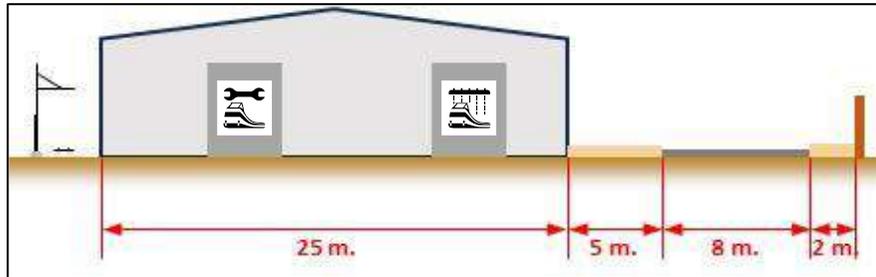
Sezione schematica Officina piccola manutenzione - lavaggio
